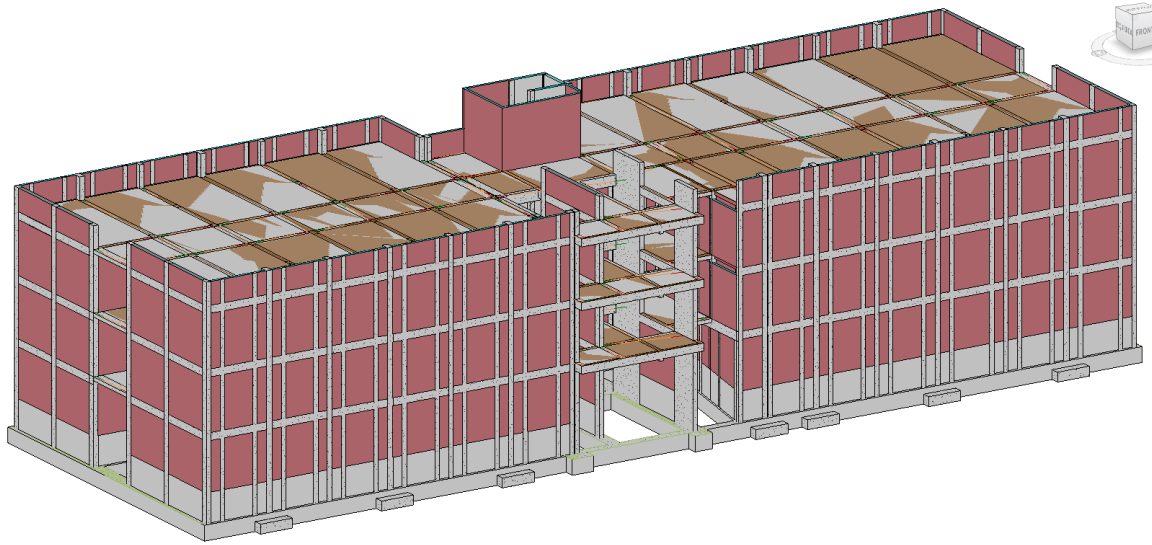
Modelo 3D – Estructuras del Pabellón B de la UNTELS
